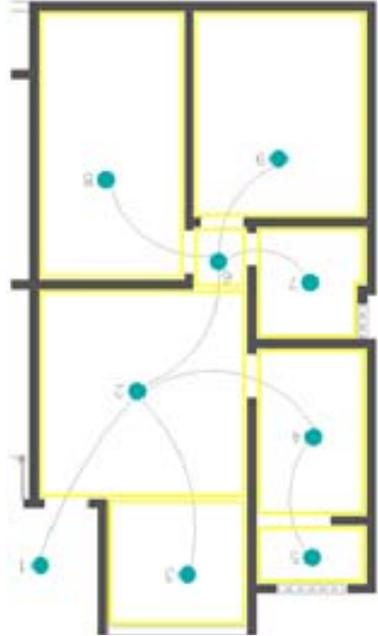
QELC 03 – Bloco A11 - Planta Modificada
